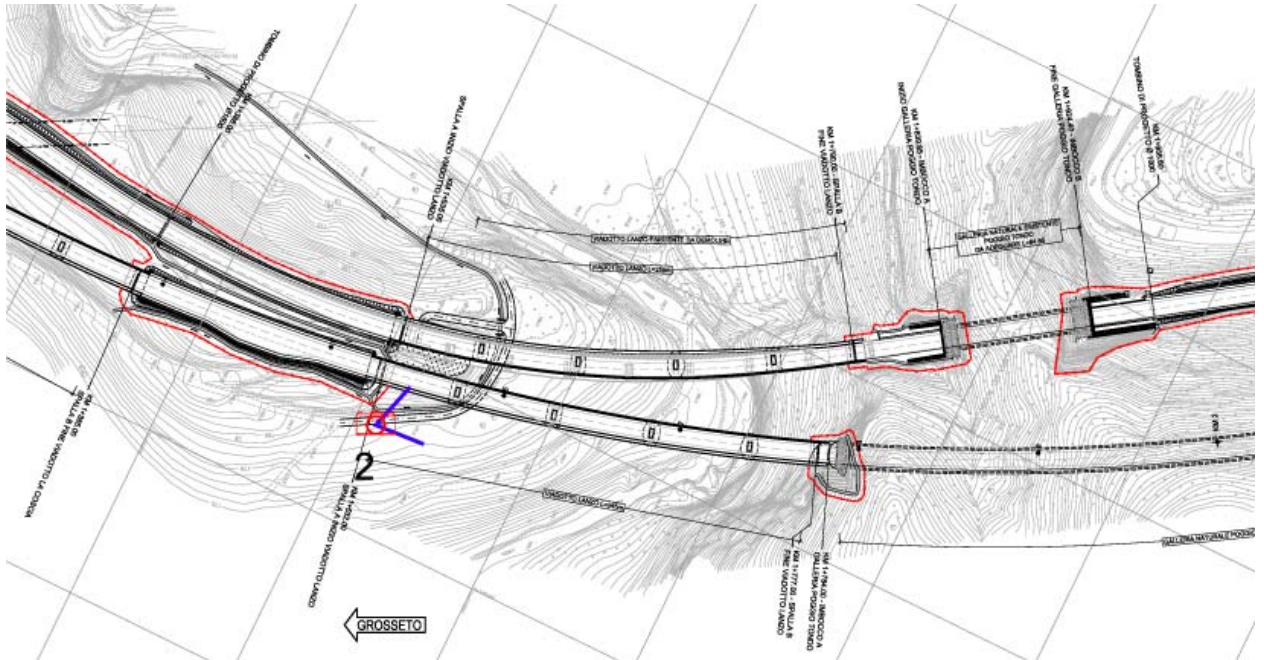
Vista 2 – Planimetria dell'opera con punto di vista fotografico
